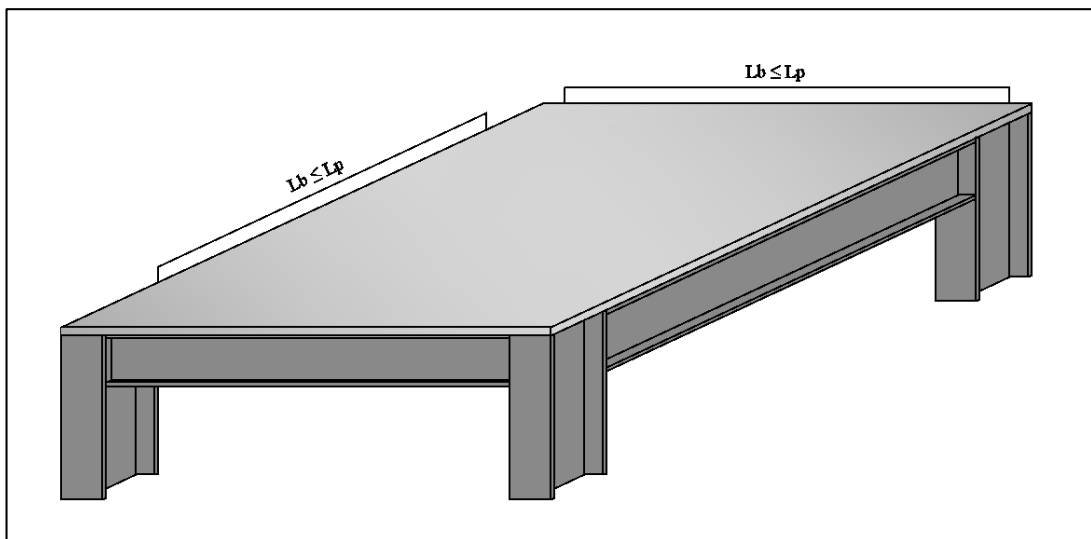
Arriostramiento Lateral Continuo de la Viga.
